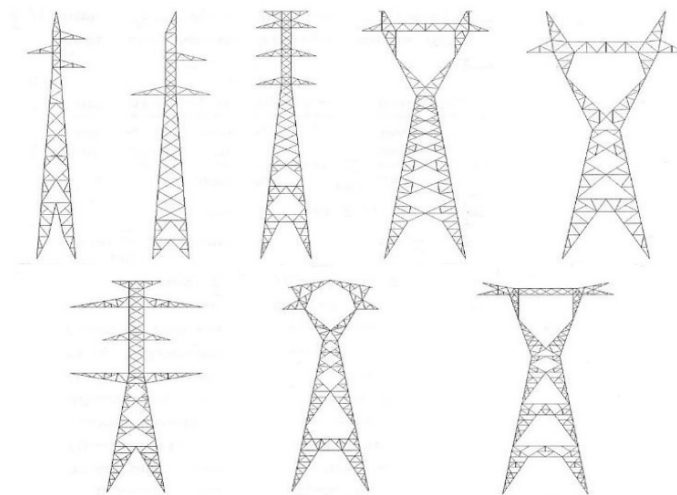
Exemplos de silhuetas de estruturas autoportantes (Fonte: Autoria própria, 2016)
